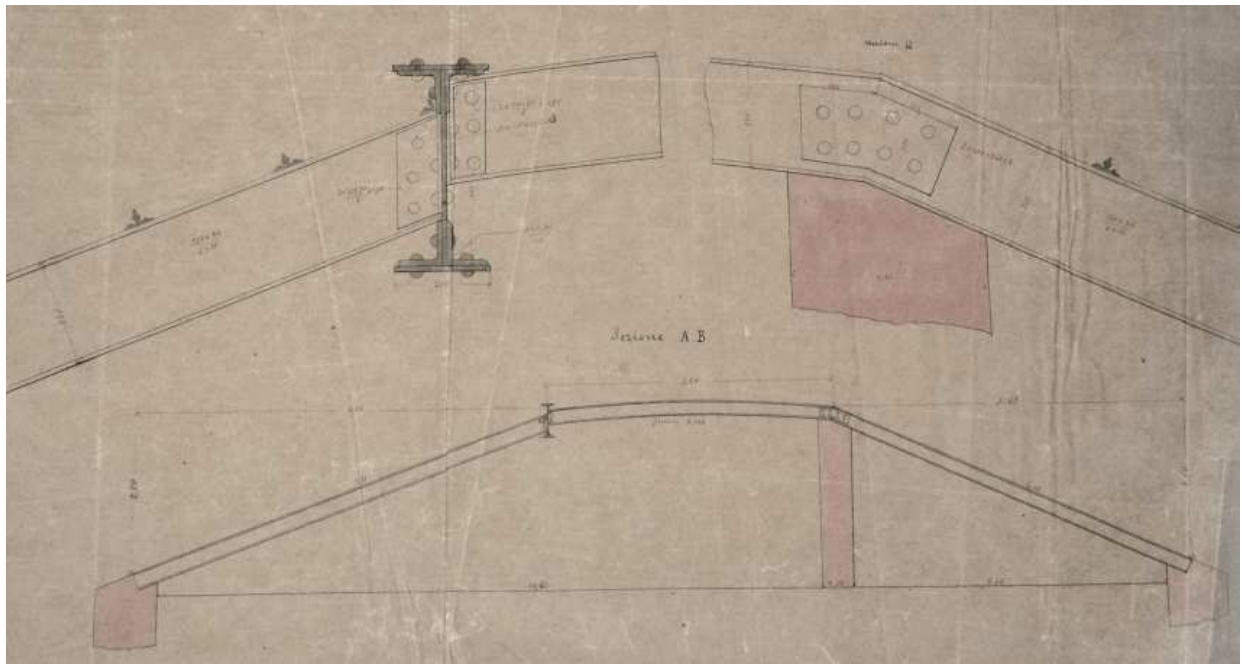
Dettagli di travi per tetto nel corpo centrale
